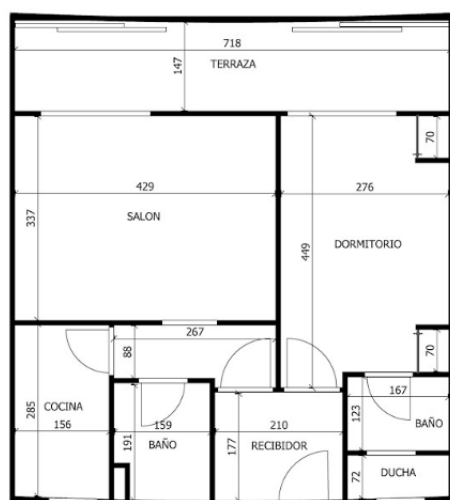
Ejemplo de plano de plantas de pisos (Fuente: Recursos Interior (2018))
